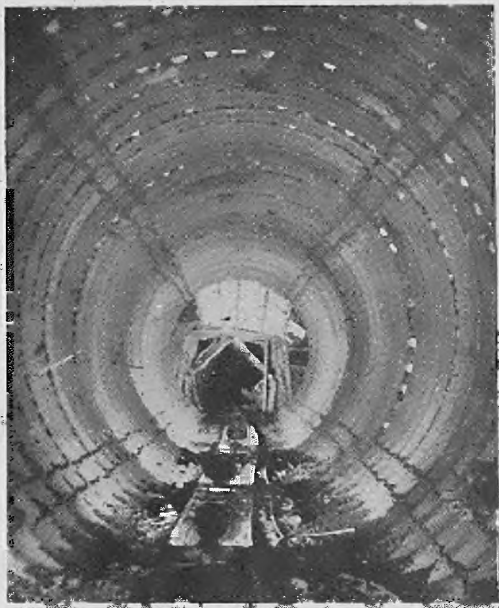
Vierteiltiger Toussaint-Heinemann-Ringausbau beim Nachbauen einer unter Druck stehenden Richtstrecke
